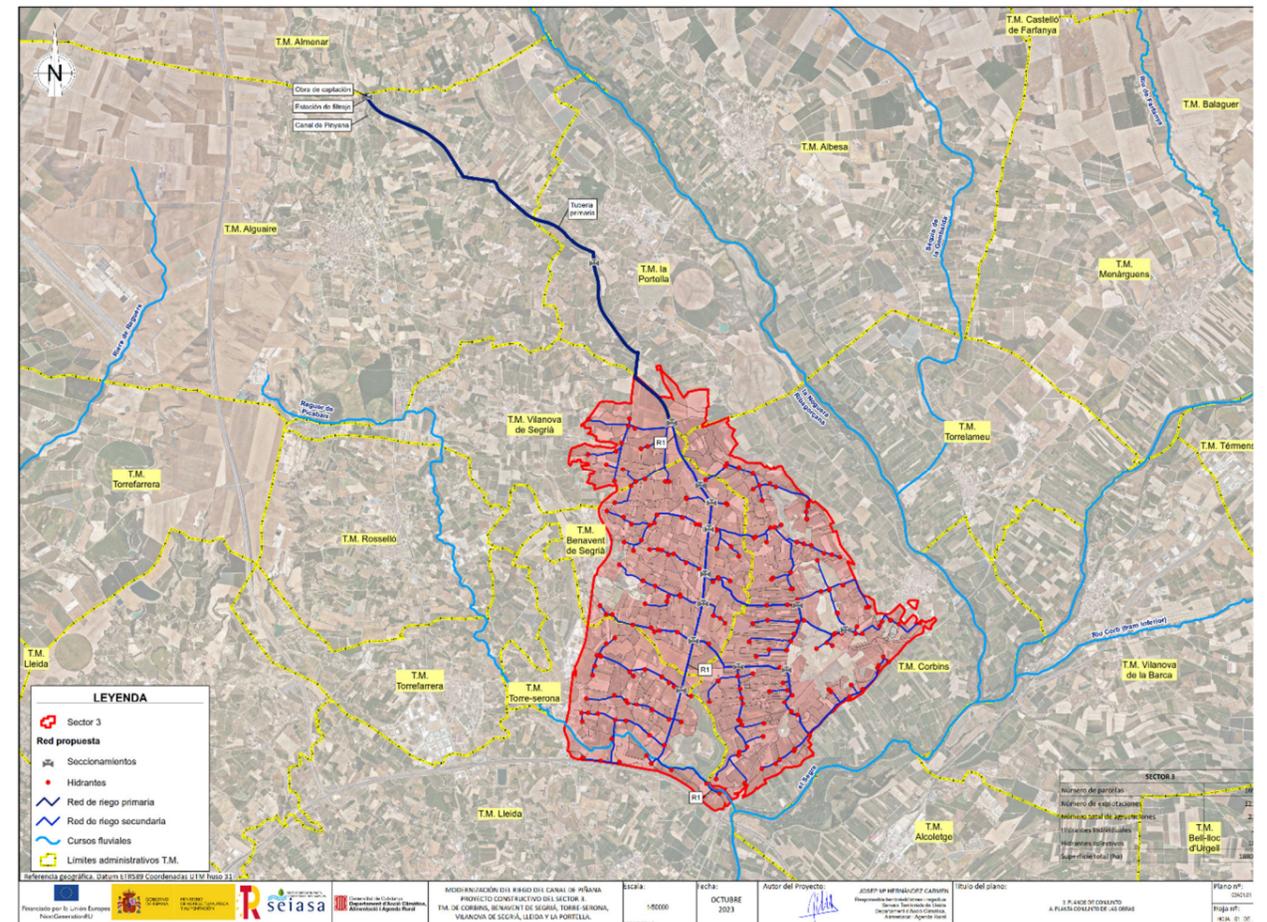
Planta general del conjunto de infraestructuras proyectadas.
